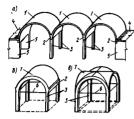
Схема погвыений распора в сводах на колоннах:
